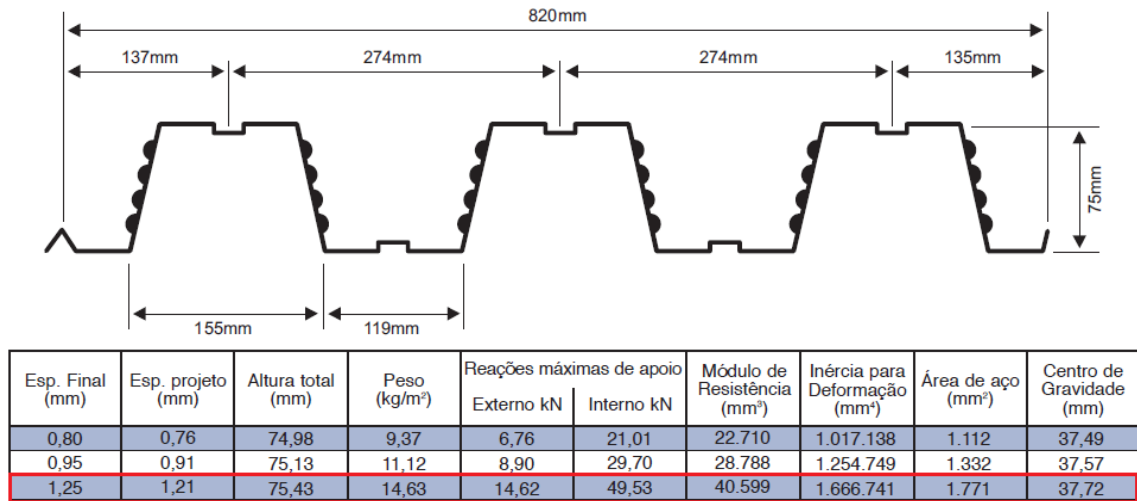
Características del Steel Deck utilizado (Bertoletti, 2014)
